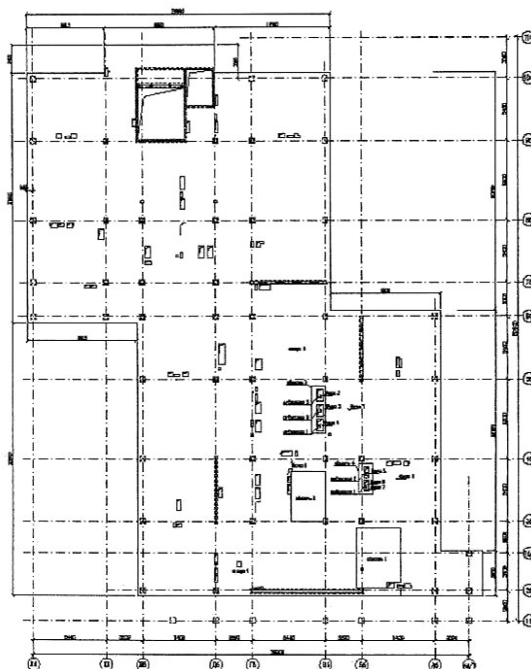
План плити перекриття 8-го поверху будівлі блоку Б
